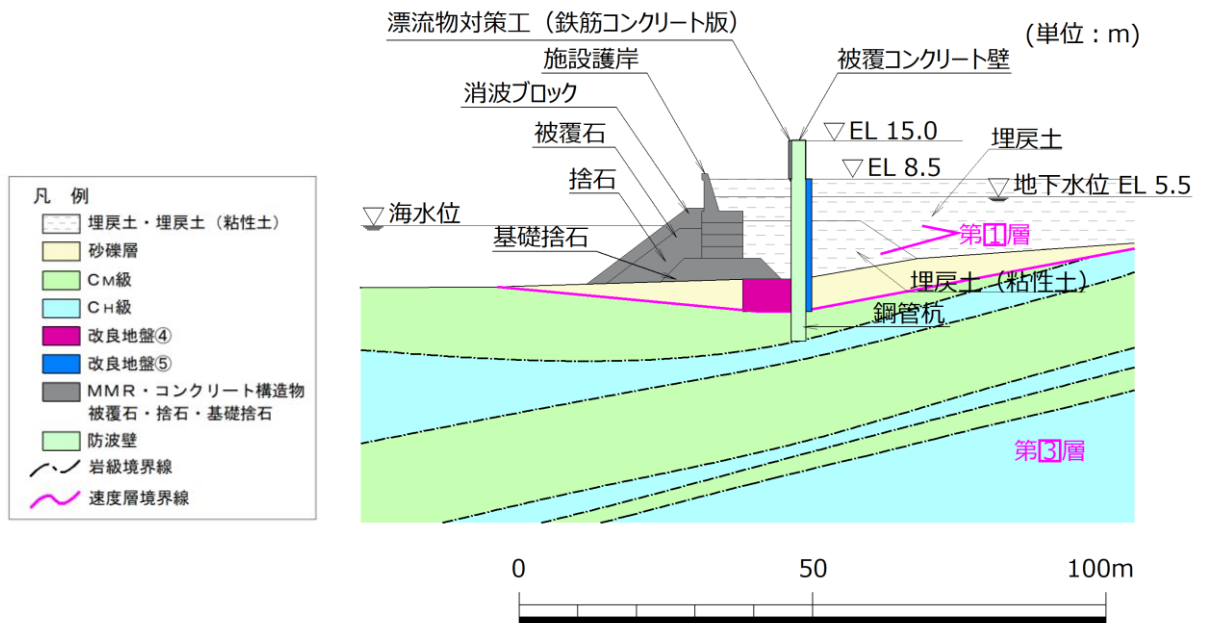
防波壁 (多重鋼管杭式擁壁) の横断面図 (②-②断面)
